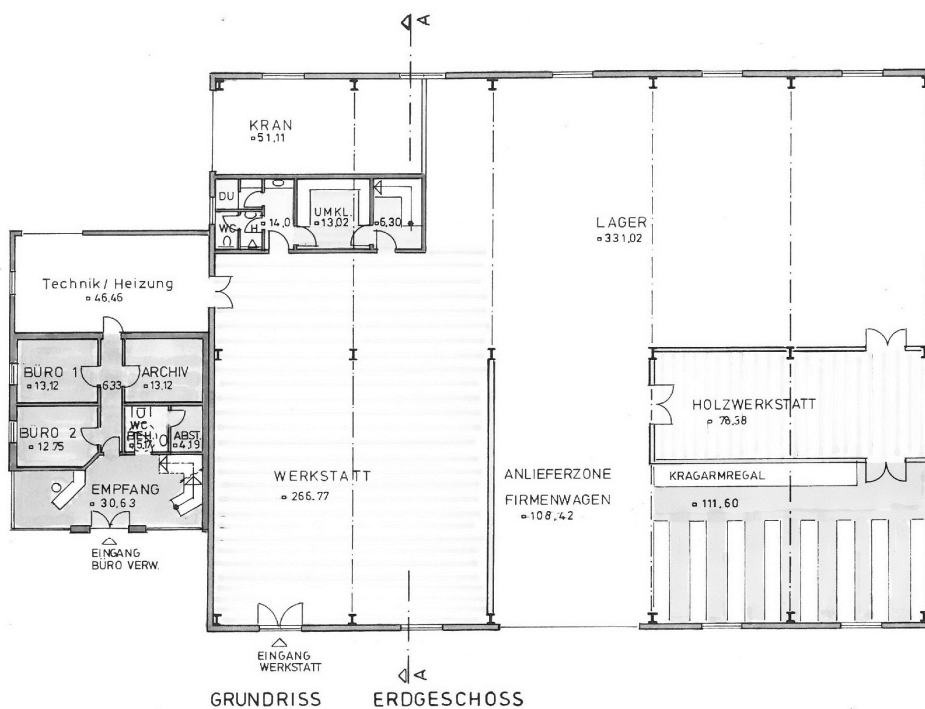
Grundriss EG der Betriebsgebäude Fa. Bobinger gemäß [b]
